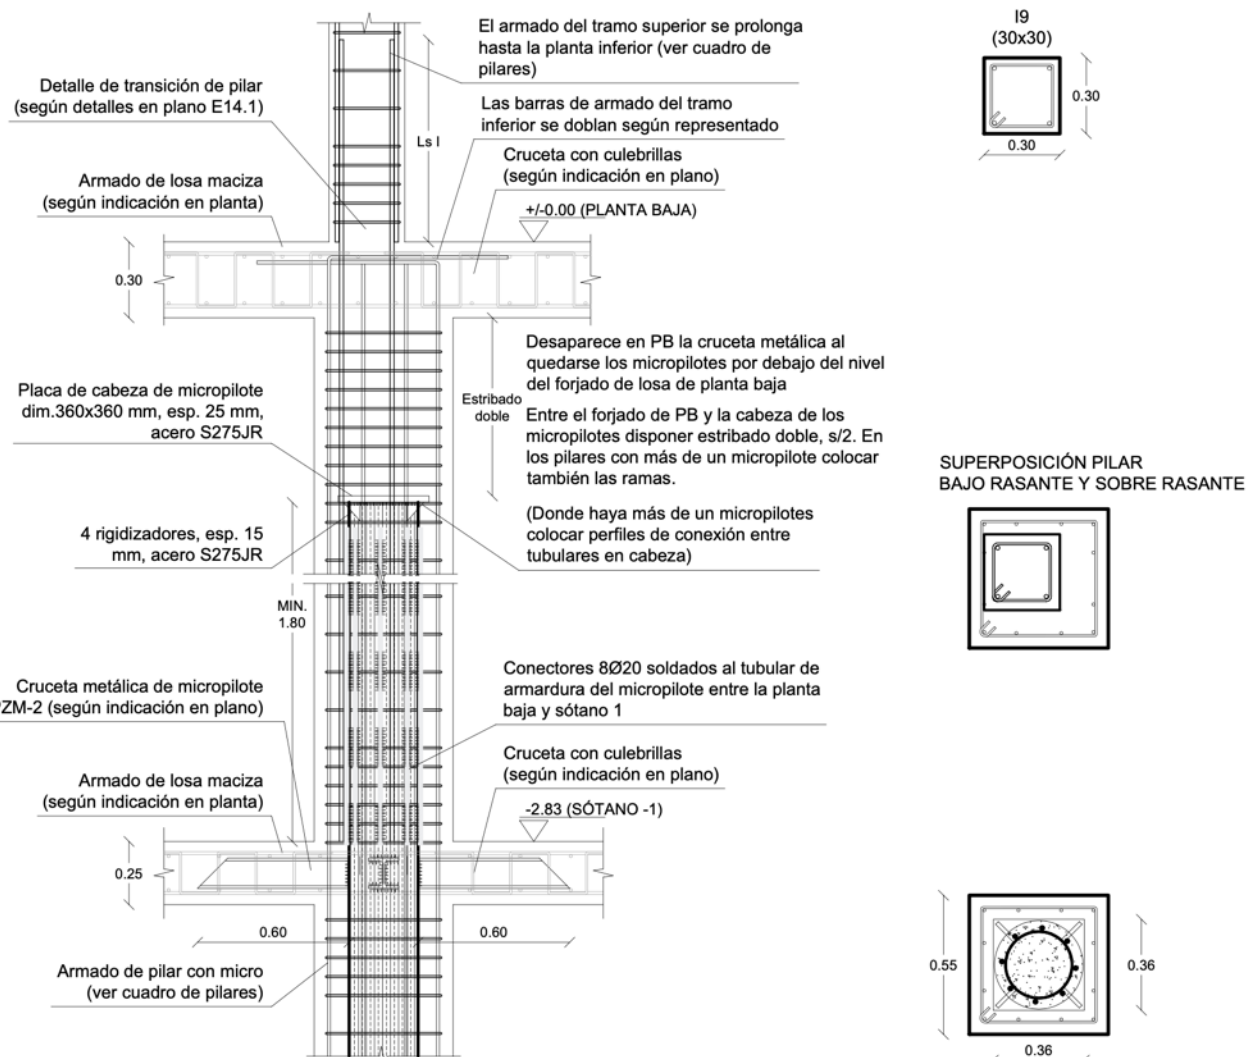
Alzado tipo de la transición de pilares bajo rasante (con micropilotes) y sobre rasante (en hormigón armado)
